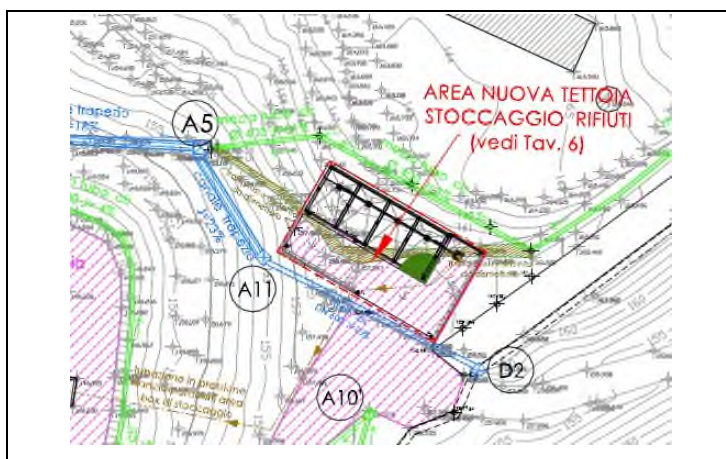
Stralcio planimetria tettoia stoccaggio rifiuti
